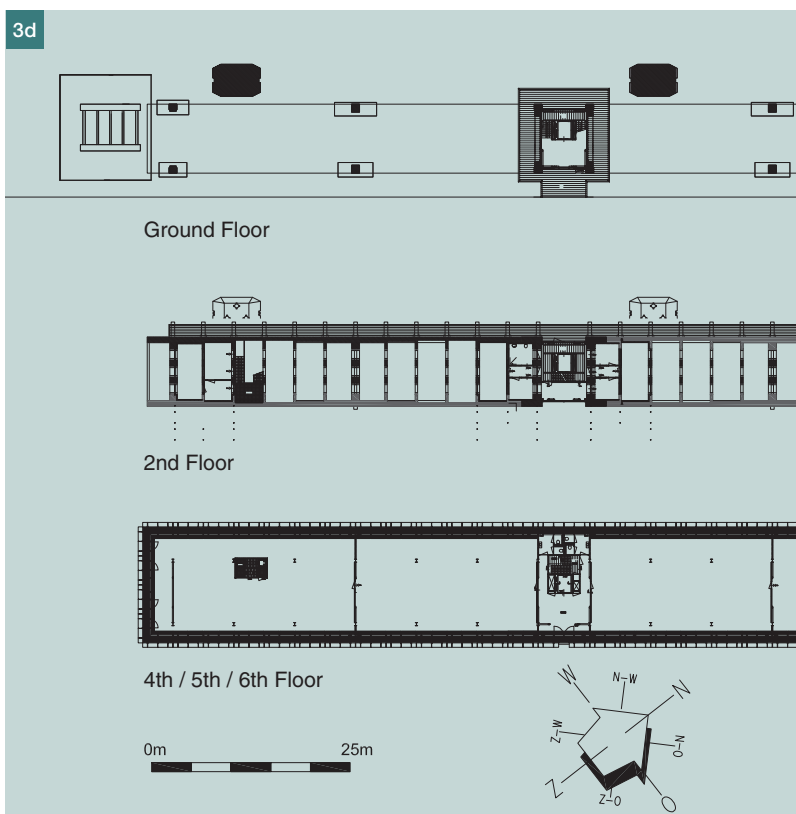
a) Situace, b,c) fasáda (jeden modul) – pohled od břehu, d) půdorys – 1., 2., 4., 5. a 6. NP ■ Fig. 3 a) Site plan, b,c) facade (one module) – land side, d) layout – ground floor, 2nd, 4th, 5th and 6th above-ground floor
